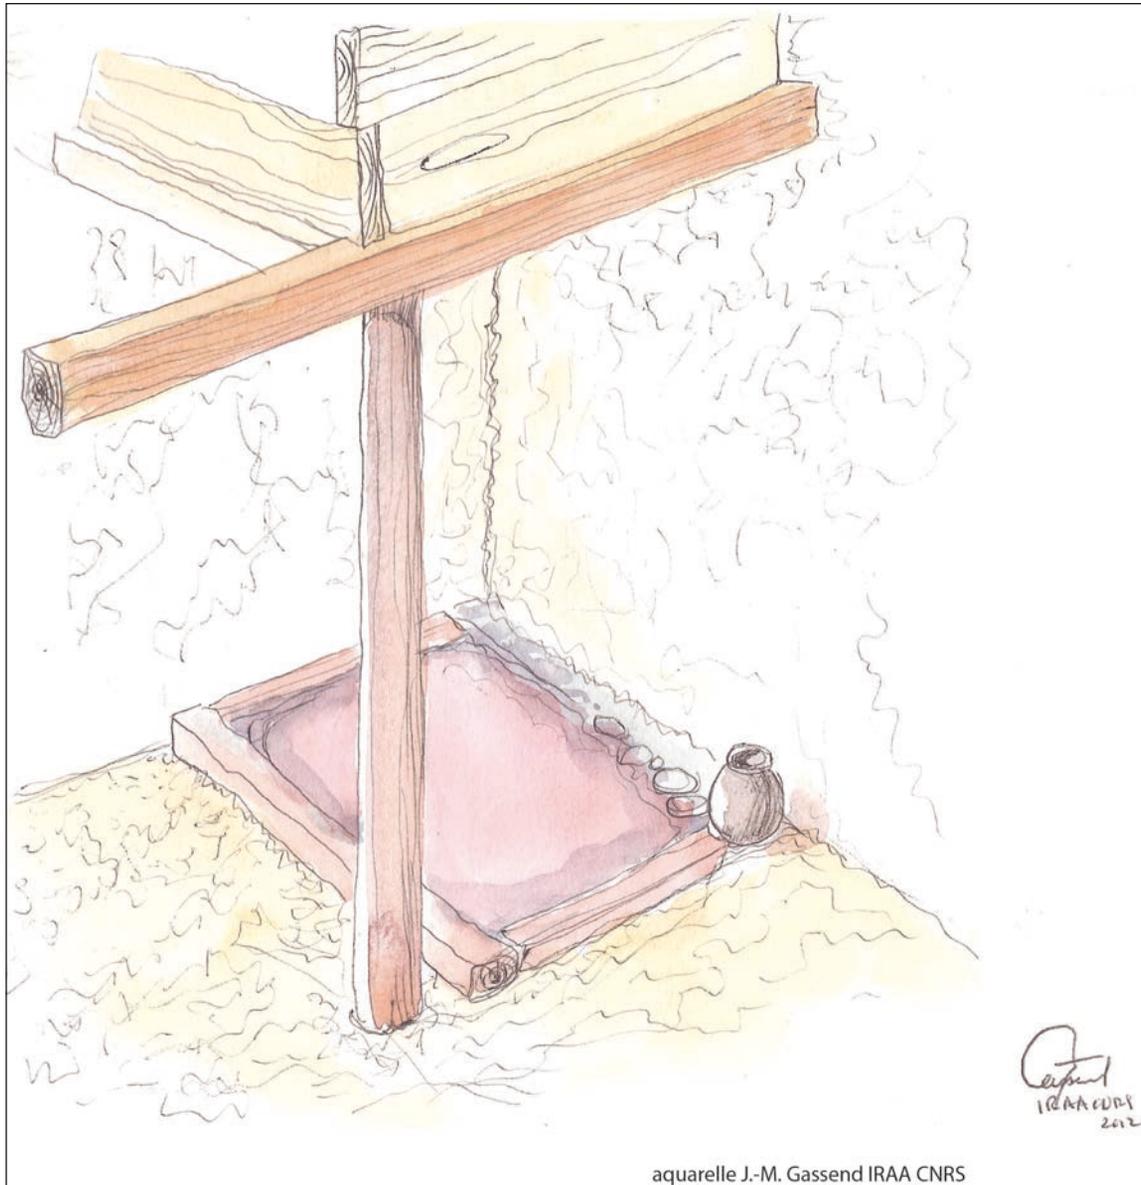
Proposition de restitution du foyer de la tour 1A, état 1.
